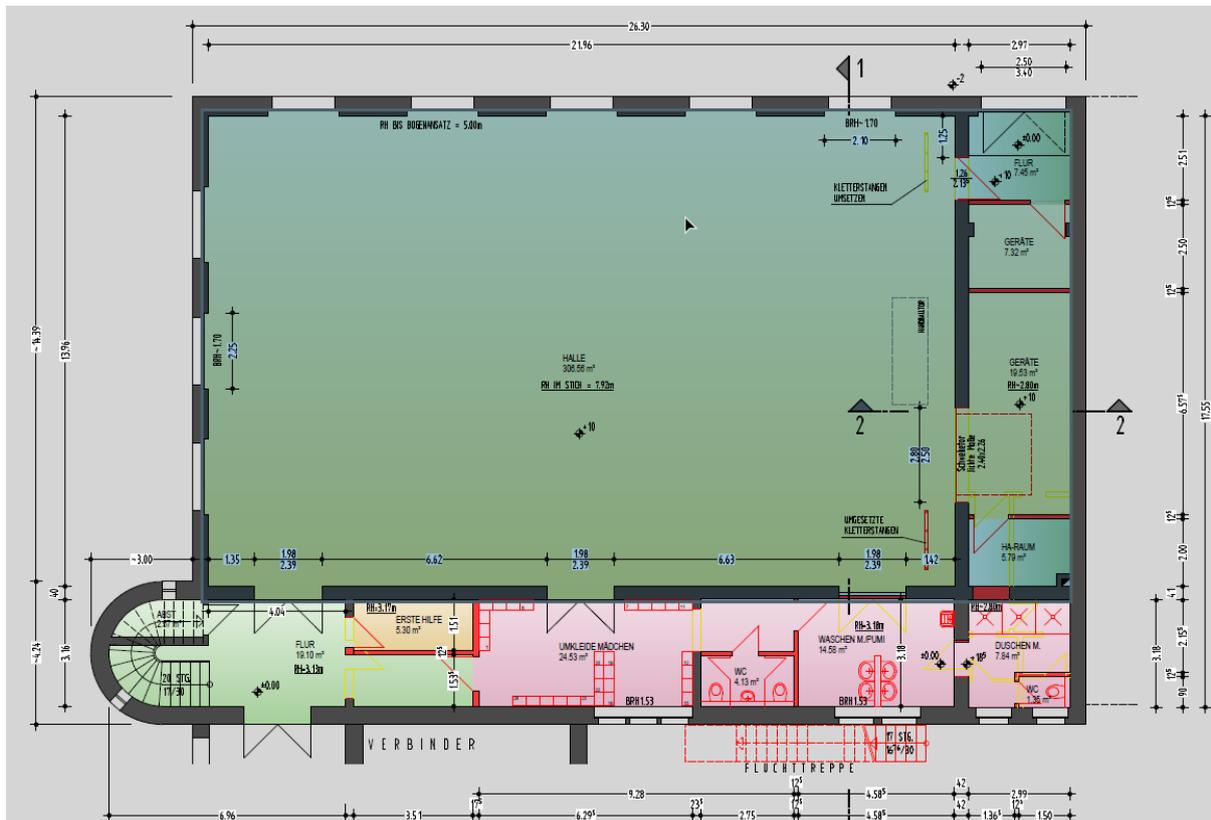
Grundriss Erdgeschoss TH 9 Erich-Weinert-Schule (Quelle ZGM)
